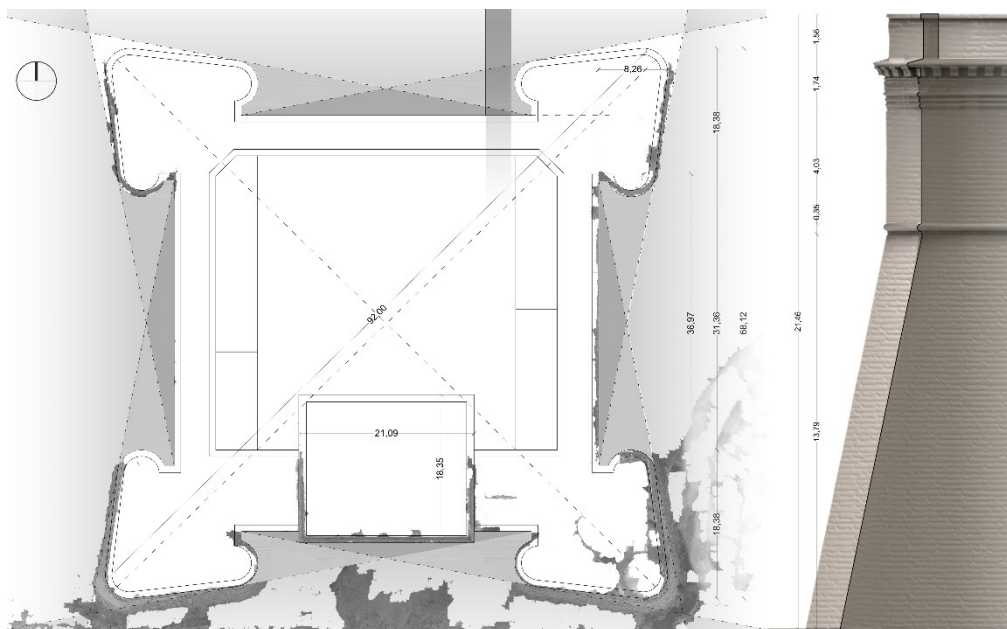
Vista planimetrica della nuvola di punti, con sovrapposta la ricostruzione geometrico – dimensionale del complesso architettonico. Evidenziati in scale di grigio le zone morte per la difesa del forte (dallo scuro al chiaro le zone sono sempre più sotto tiro dell'artiglieria)
